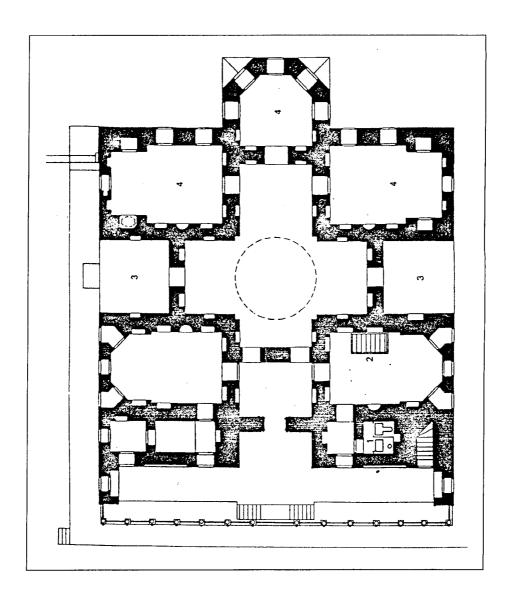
مكرر) مسقط أفقي لطوب قابي سراى بإستانبول (عن : جودوين) .
